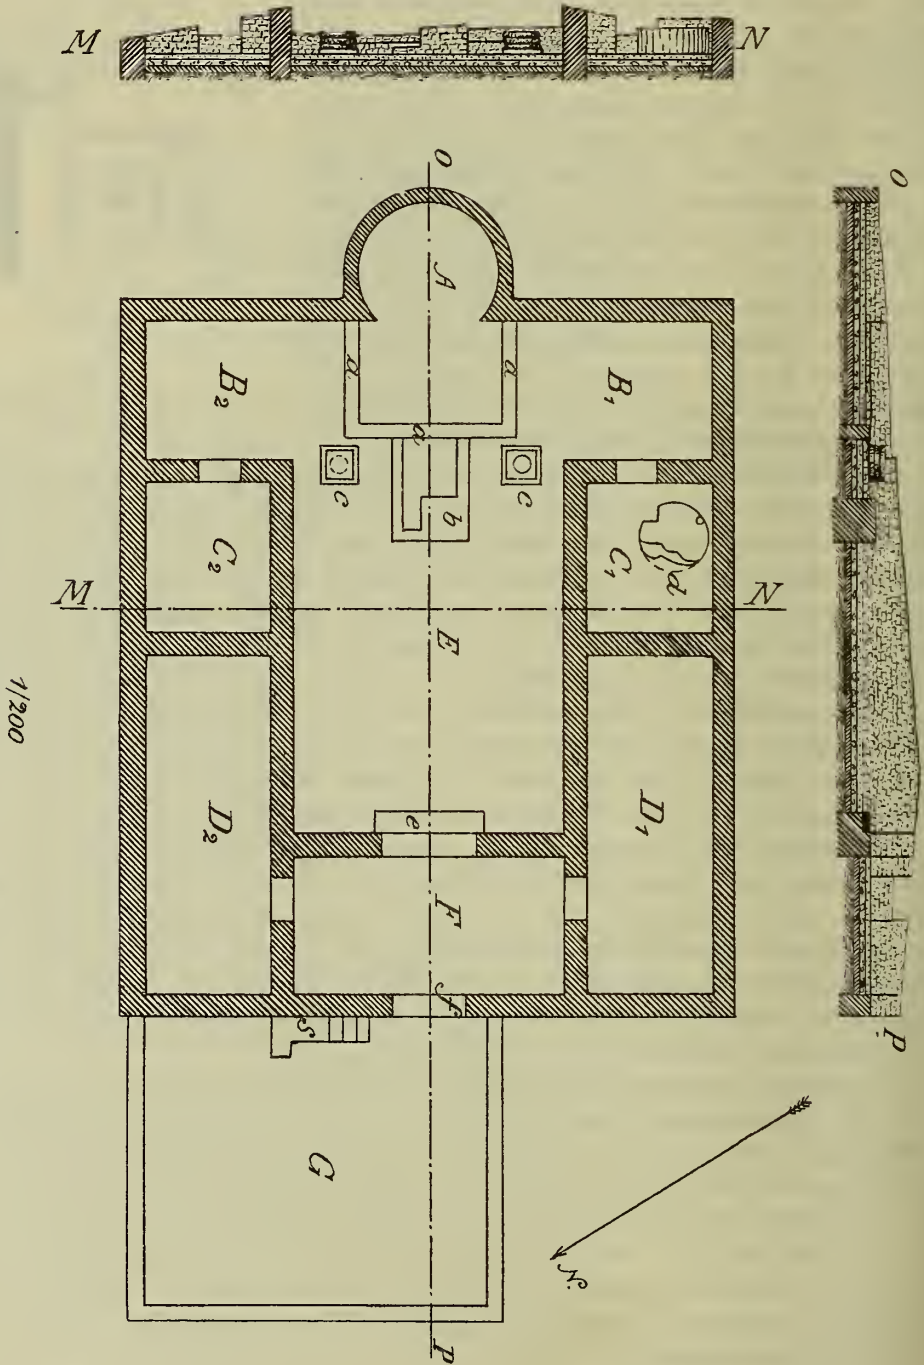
Grundriss eines römischen Gebäudes in Magdon.
